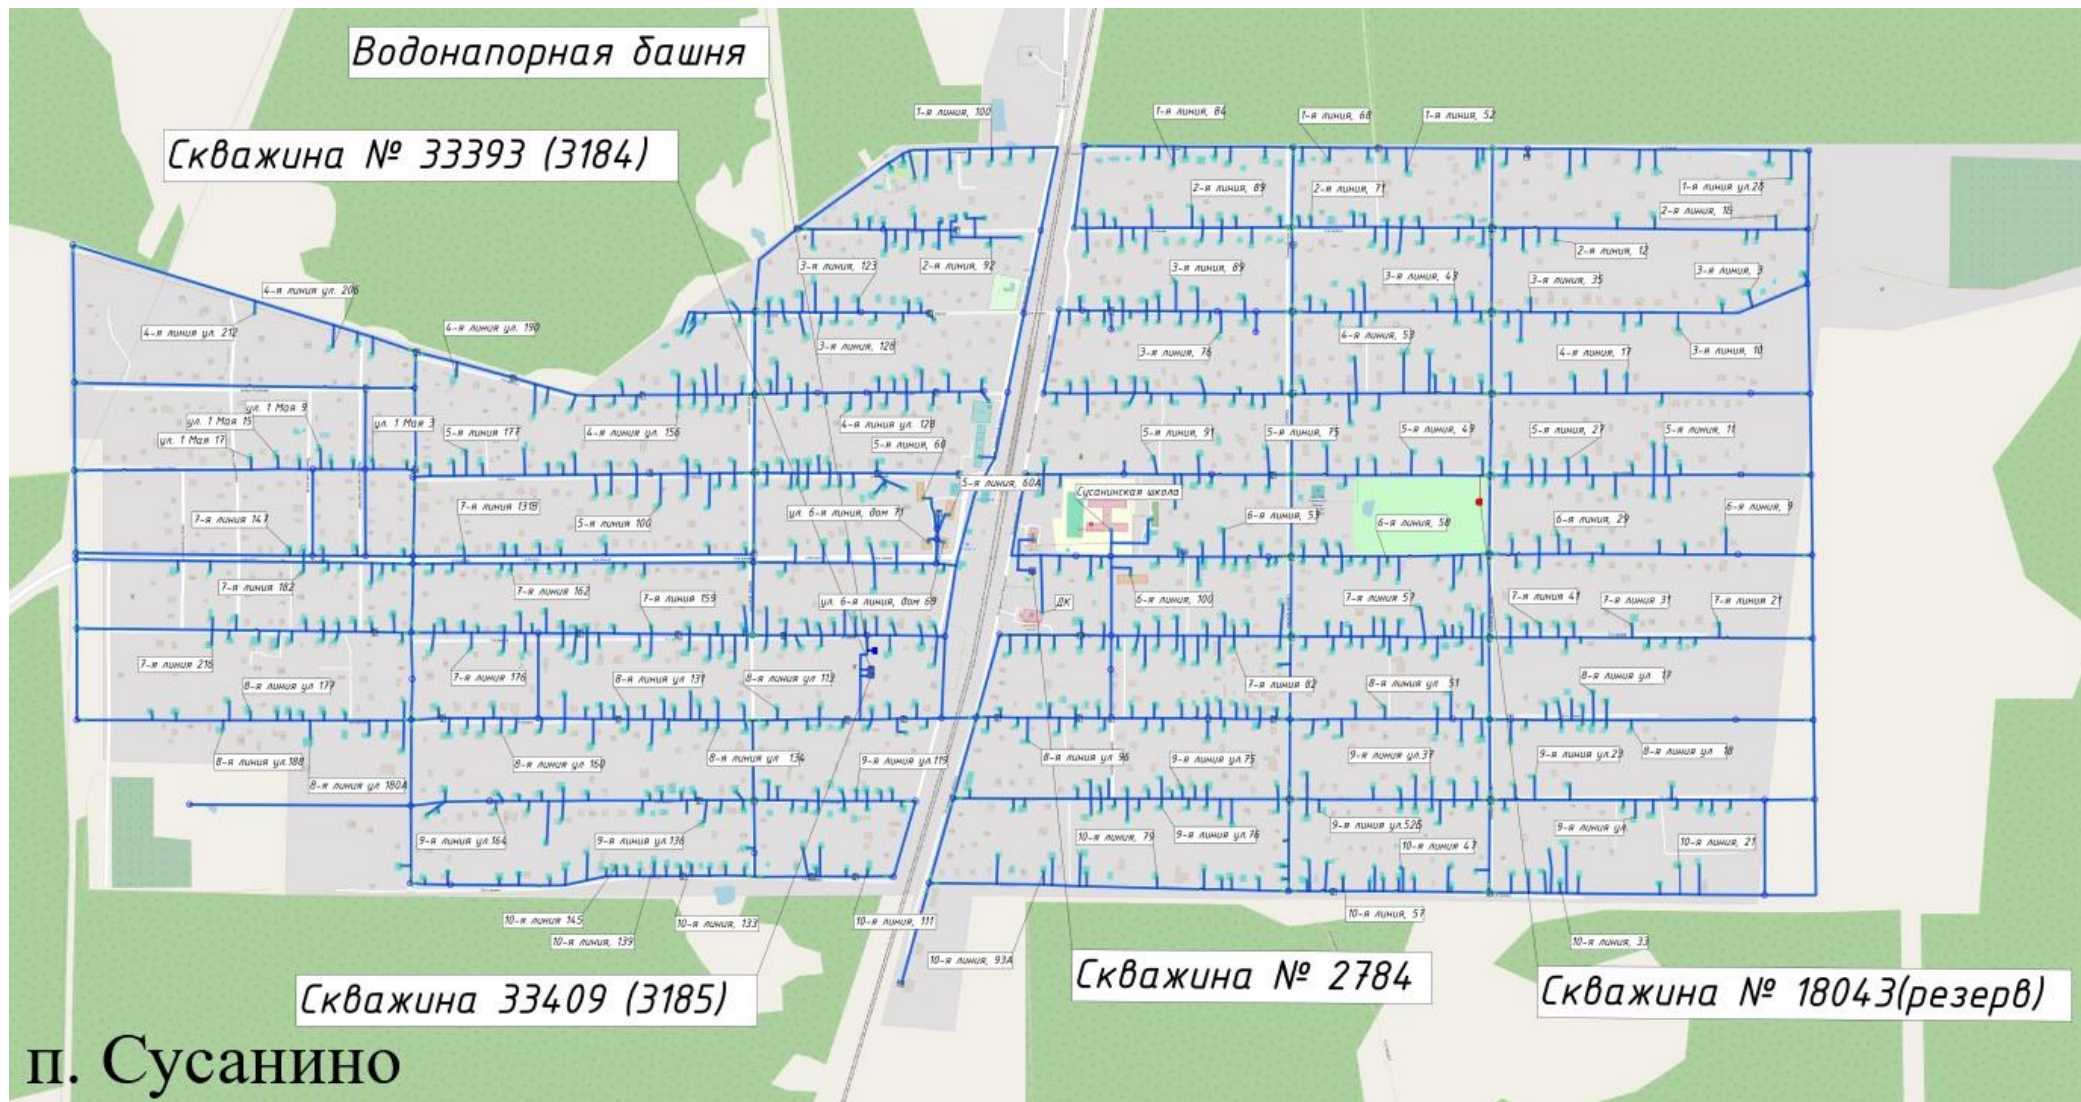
Схема водопроводных сетей системы водоснабжения п. Сусанино
